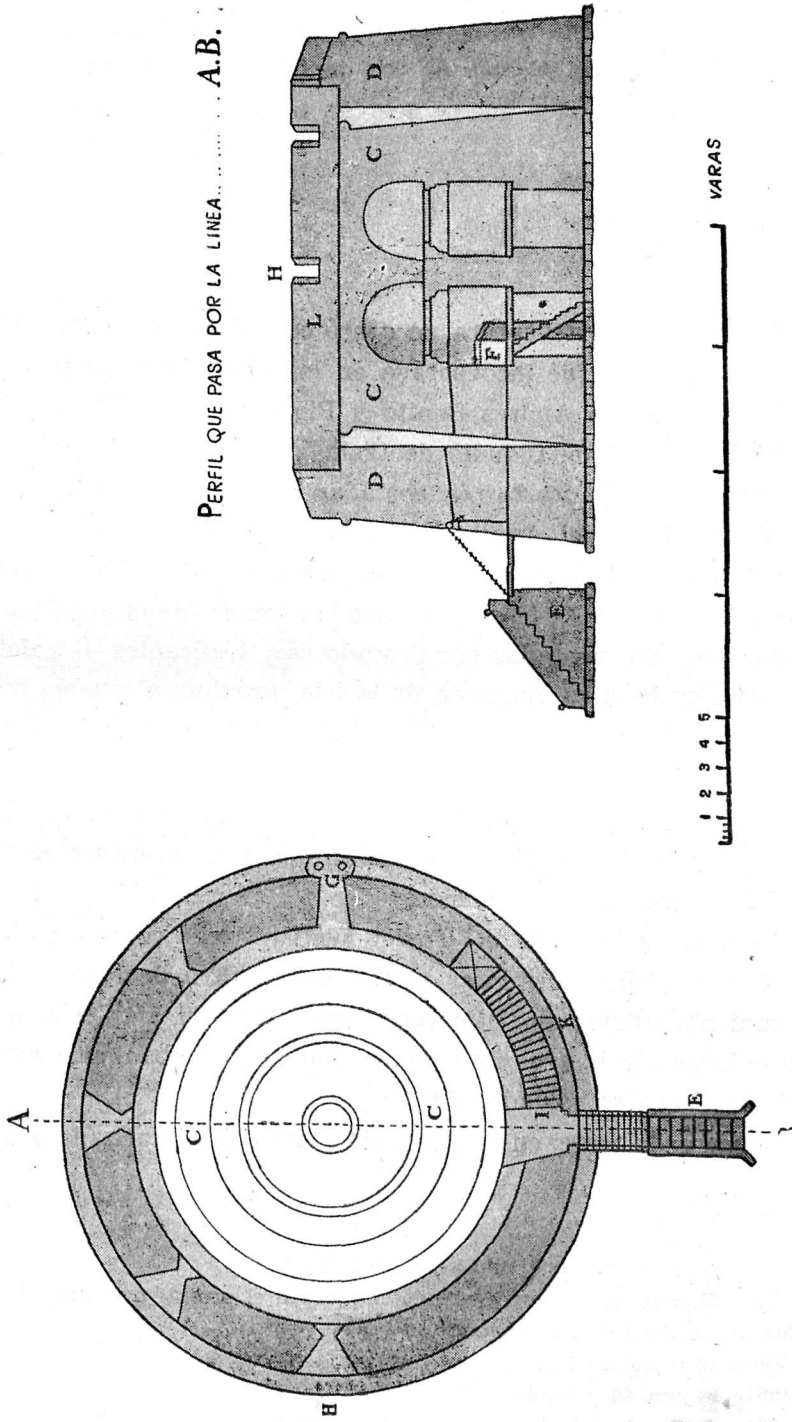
Plano de la torre de San Buenaventura (Caleta de Fustes). Por el ingeniero Alejandro de los Angeles.
